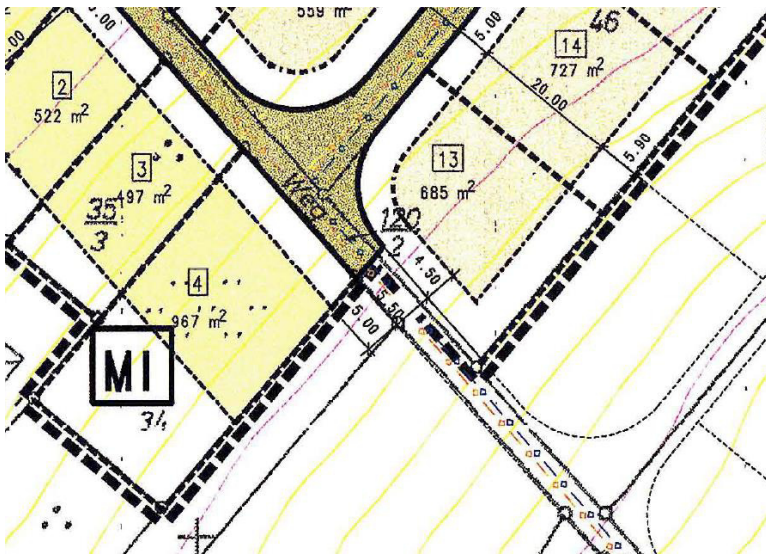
Ausschnitt B-Plan „Am Holzapfelbaum II“ Nordwest
